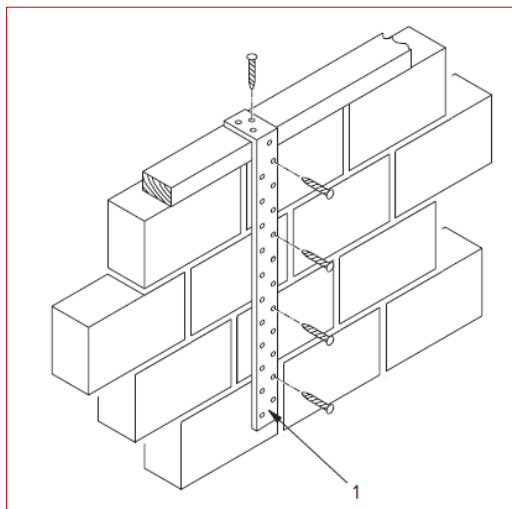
Exemple de bride d'ancrage de toit sur le mur
